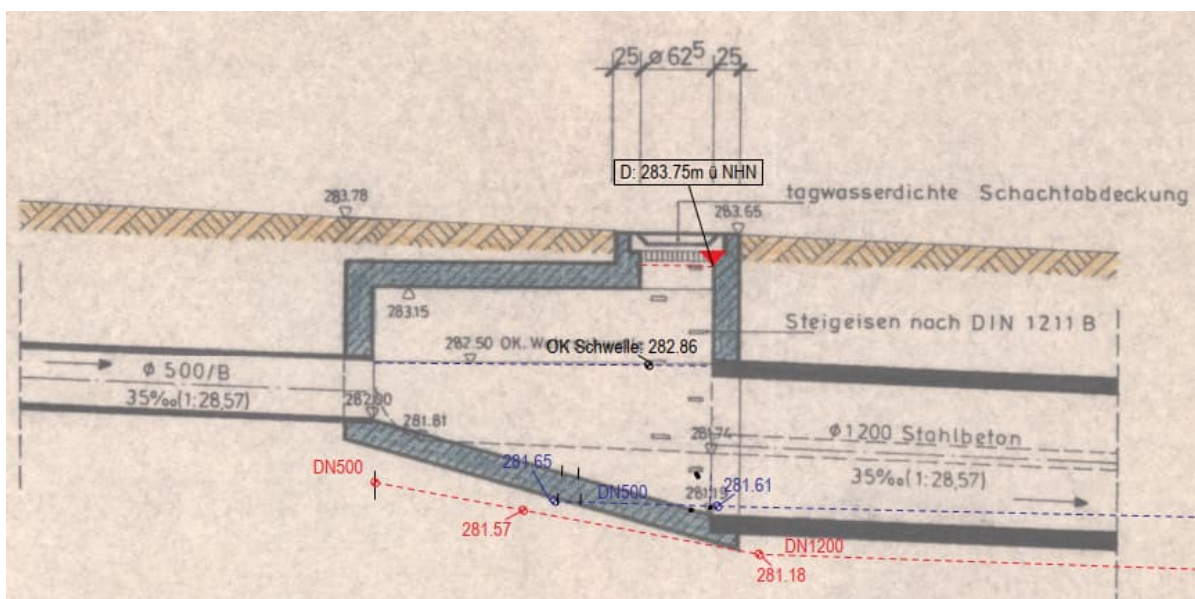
Schnitt Überlaufbauwerk SRK 2 Tambach Wildpark
